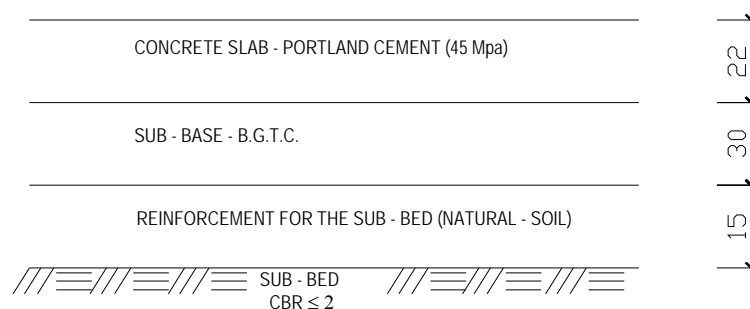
Estrutura da pavimentação da canaleta e faixa exclusiva para ônibus
